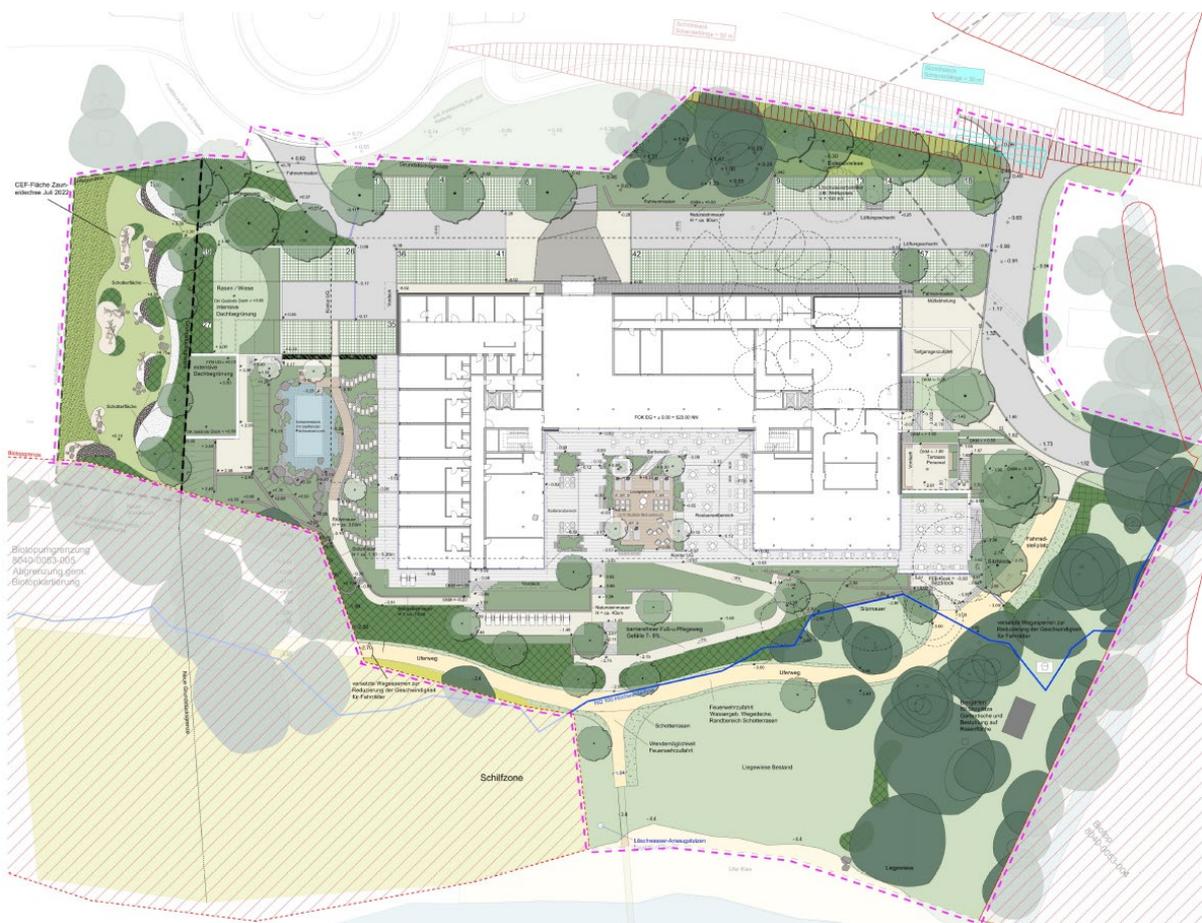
Freiflächen Gesamtplan Vorentwurf, erstellt Büro A. Oberbauer, Stand 10.02.2025
